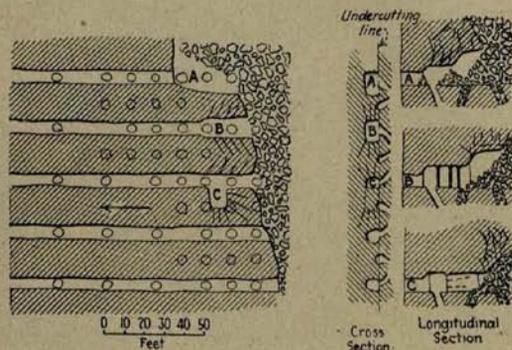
Detalle del descalzamiento practicado en Inspiration
